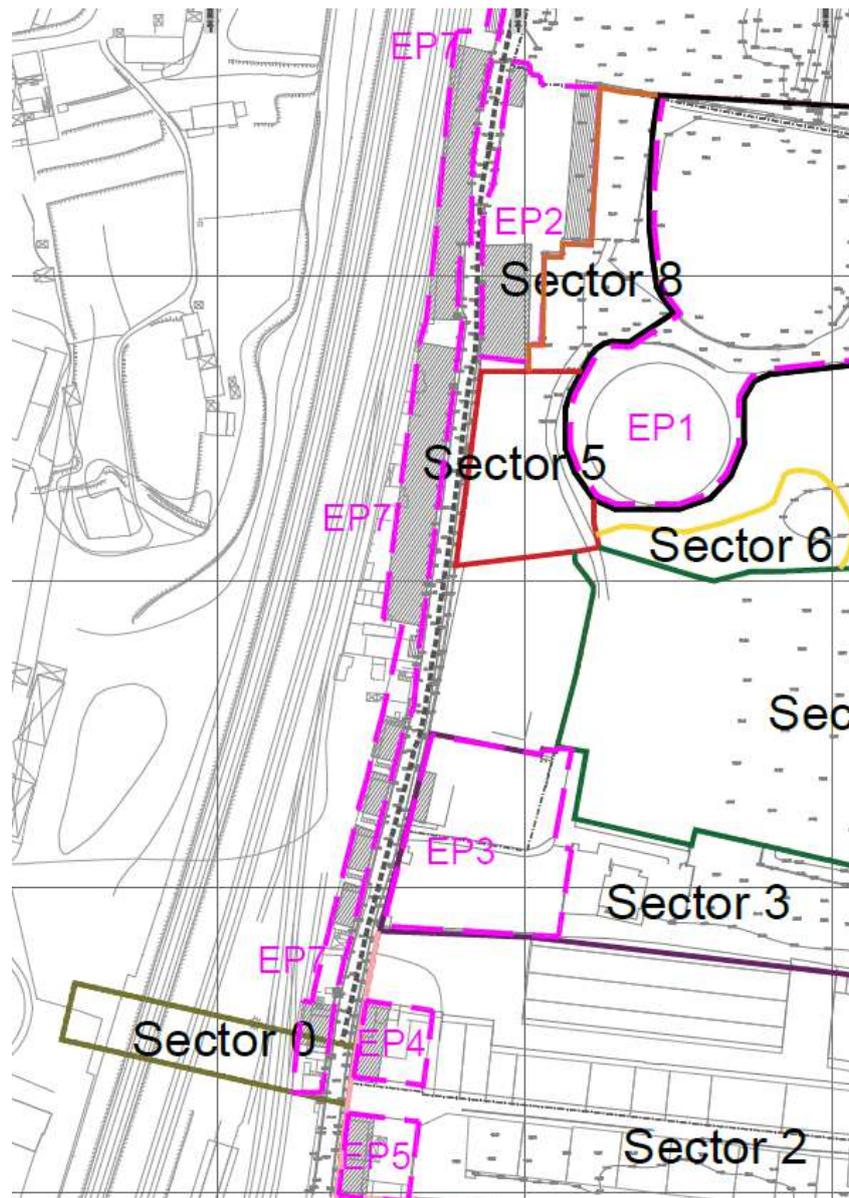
Pormenor da localização do EP4 no levantamento topográfico do Loteamento B. (escala não apresentada) -
